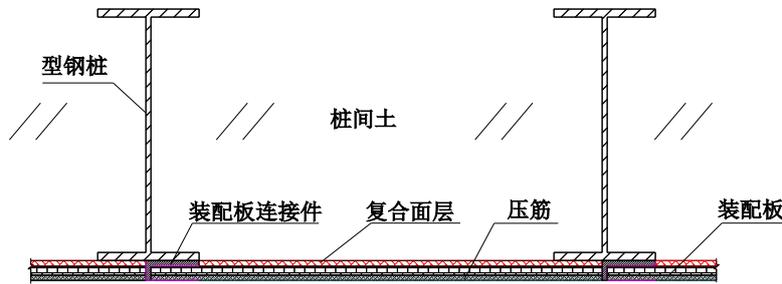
外侧 L 型钢筋连接装配式面板剖面图
